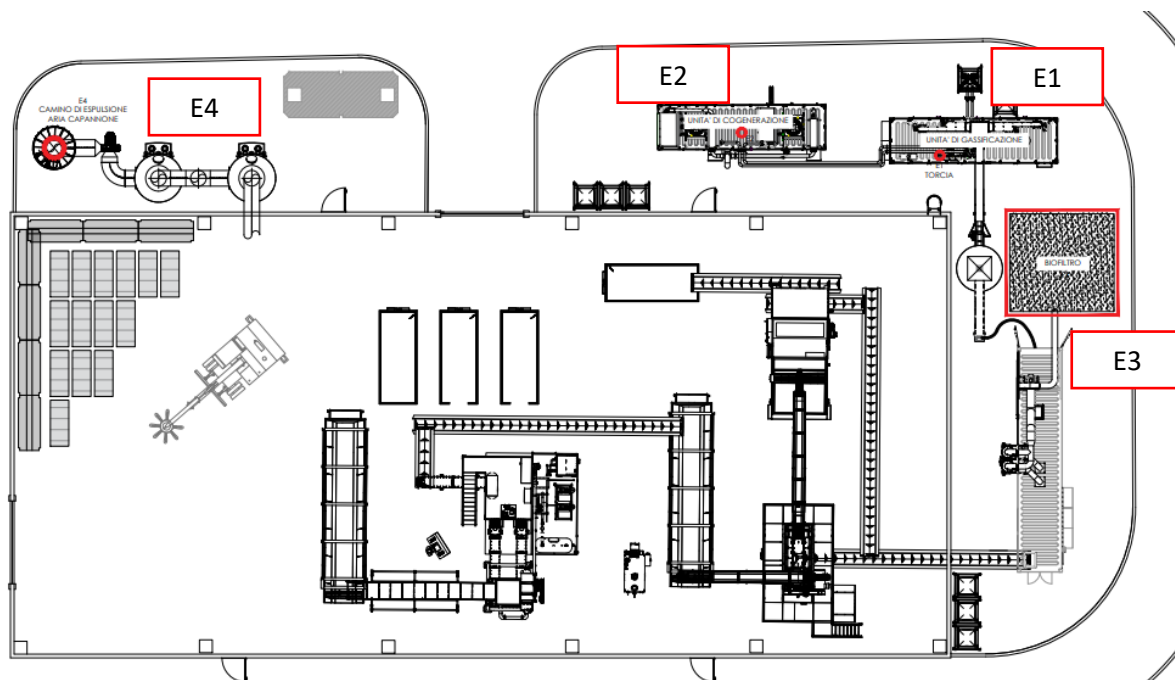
Planimetria con individuazione delle sorgenti emissive - stato di progetto
